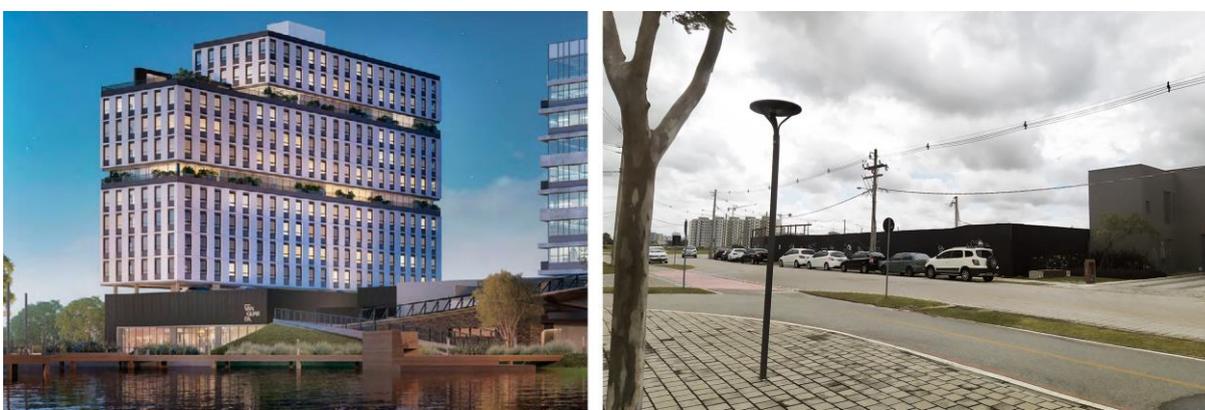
Projeto e foto as obras do Edifício Vanguarda.
